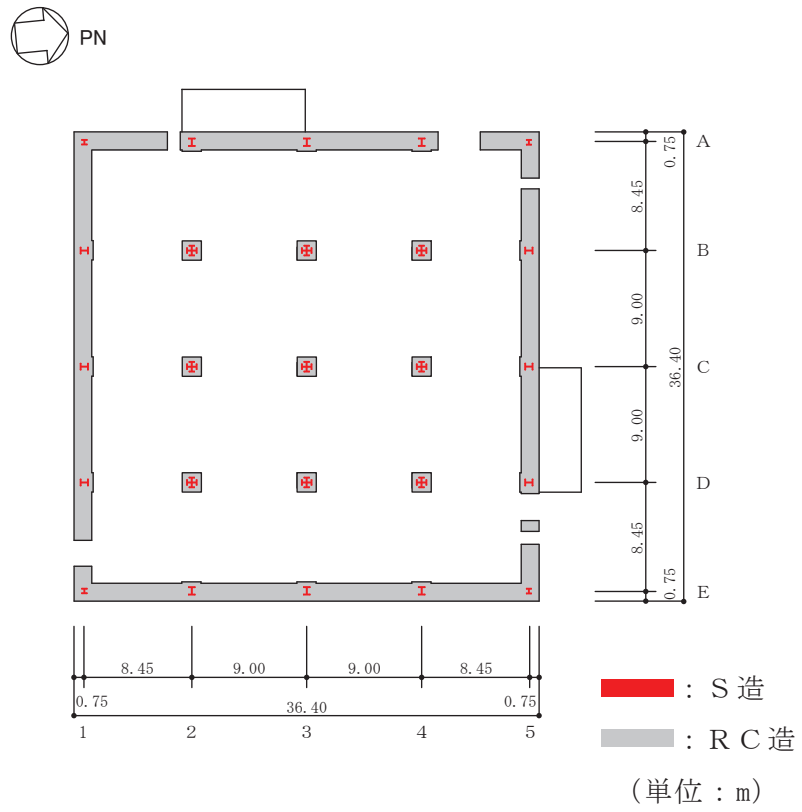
(3) 緊急時対策建屋の概略平面図 (0.P.62.2m)
